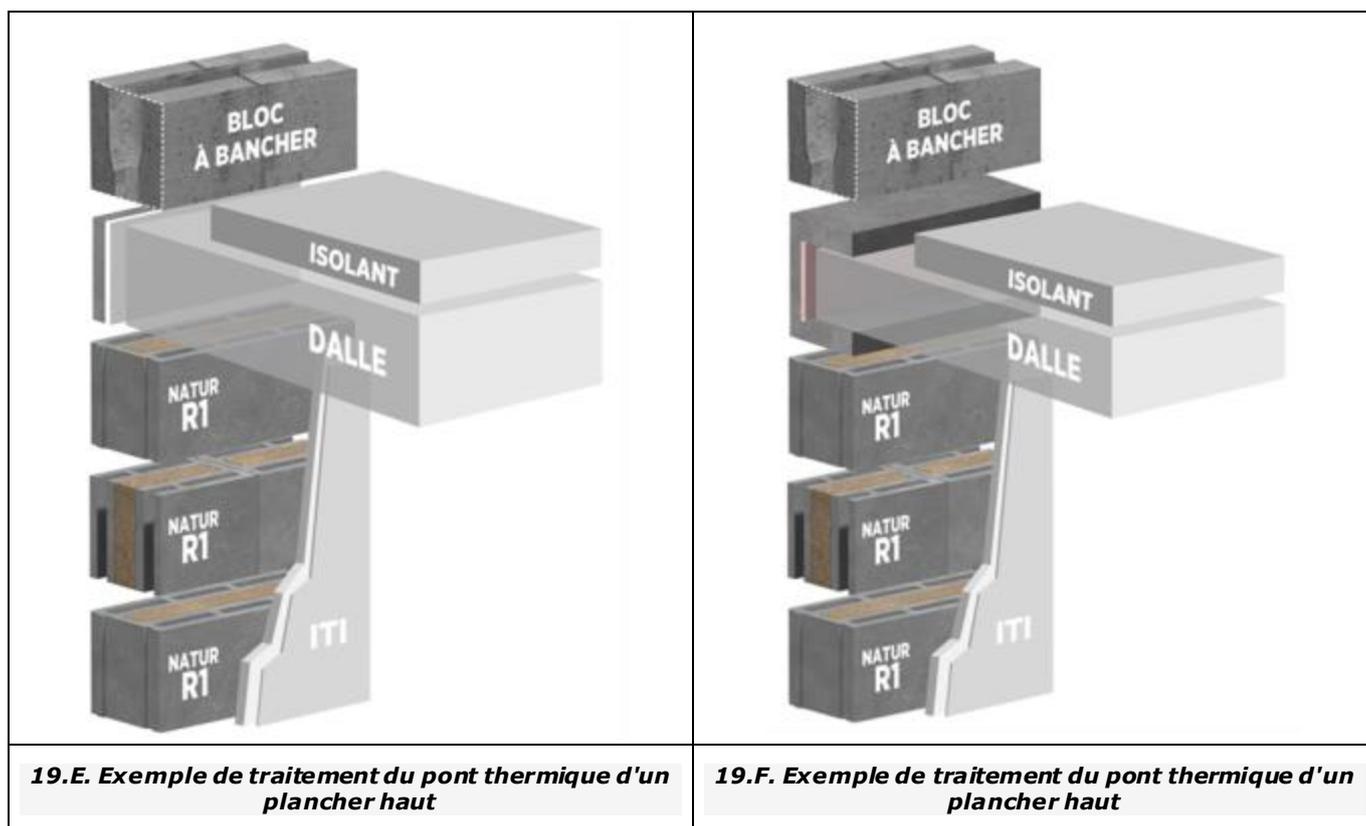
Exemples jonctions entre planchers et murs de façade de la gamme R1 (uniquement : les blocs NATUR R1)
